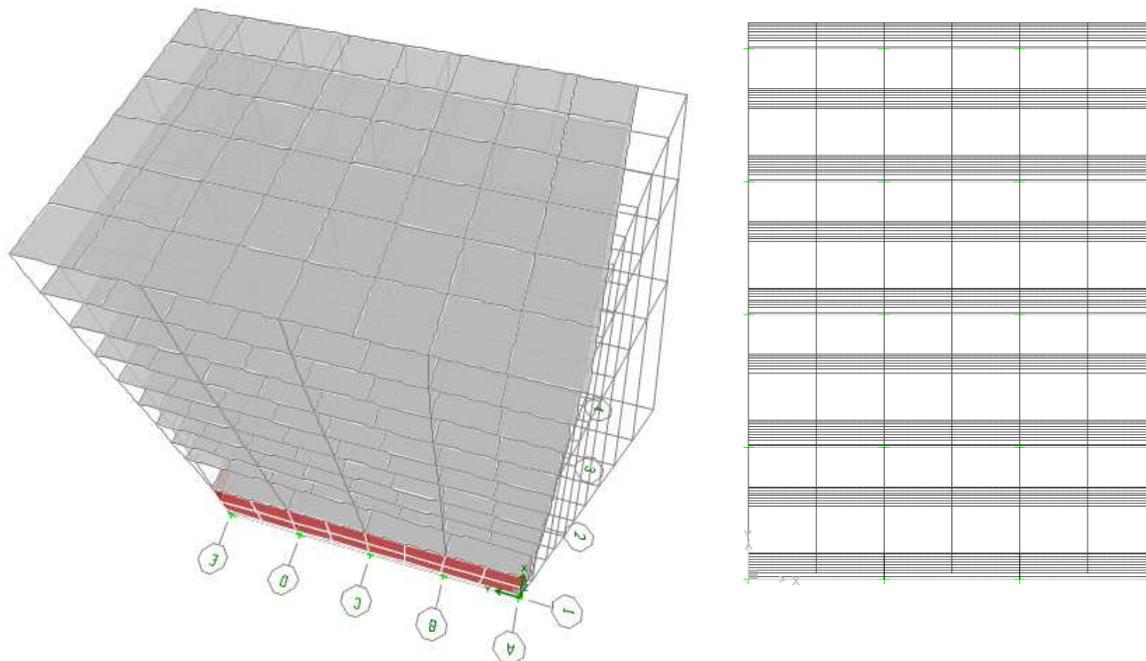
Vista en elevación y planta de la deformada del segundo modo de vibrar del edificio de 9 niveles
